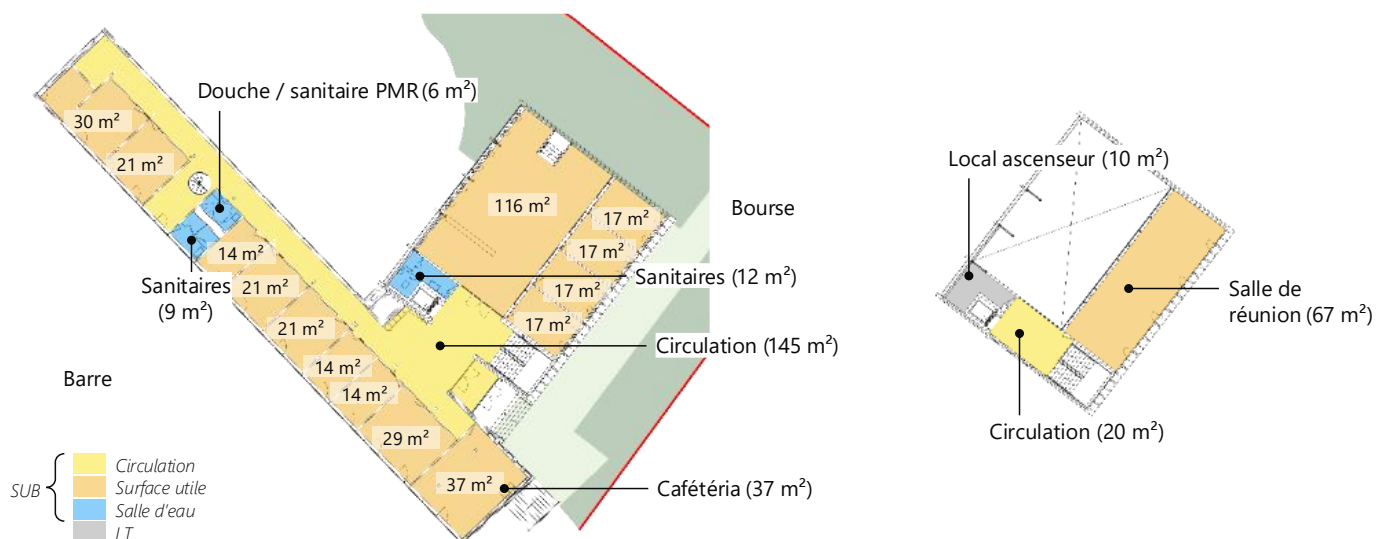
Plan RDC et mezzanine – Source : Egis sur fond de plan Carrière Didier Gazeau Architecte
